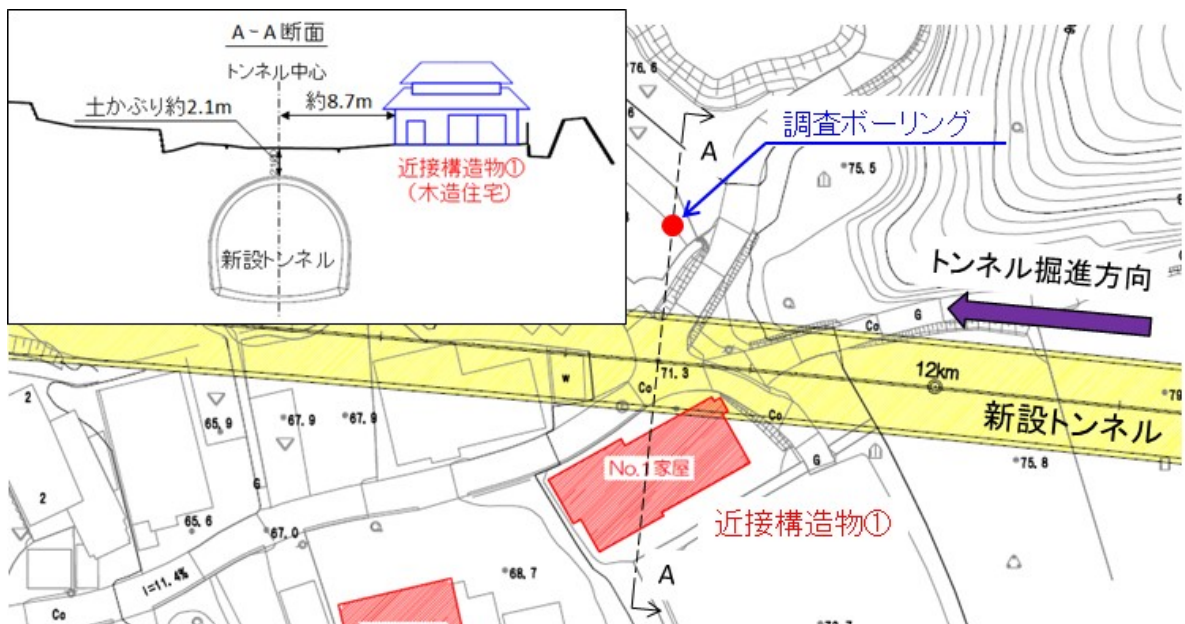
新設トンネルと近接構造物の位置関係（平面図および断面図）
